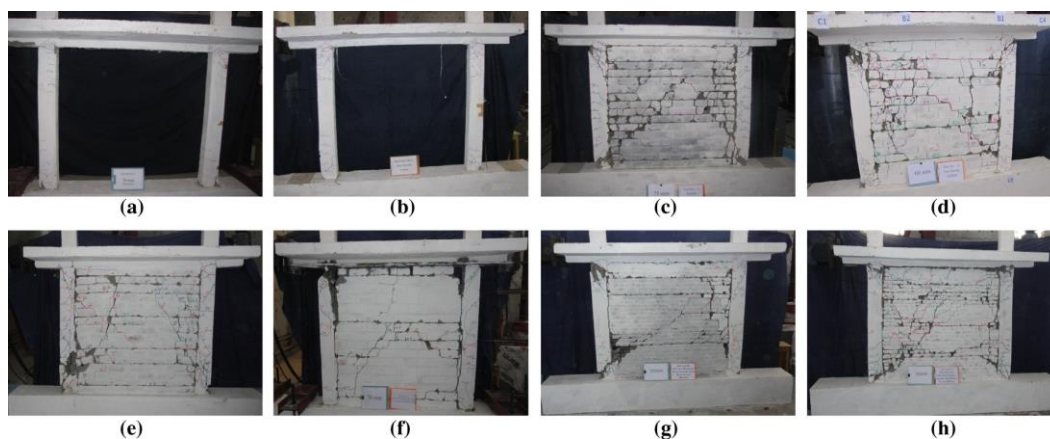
Mecanismos de falla en las muestras: (a) Pórtico dúctil sin mampostería; (b) Pórtico sin mampostería no dúctil; (c) Pórtico dúctil con mampostería de ladrillos; (d) Pórtico no dúctil con mampostería de ladrillos; (e) Pórtico dúctil relleno con ladrillo. Fuente: (Basha & Kaushik, 2016)
